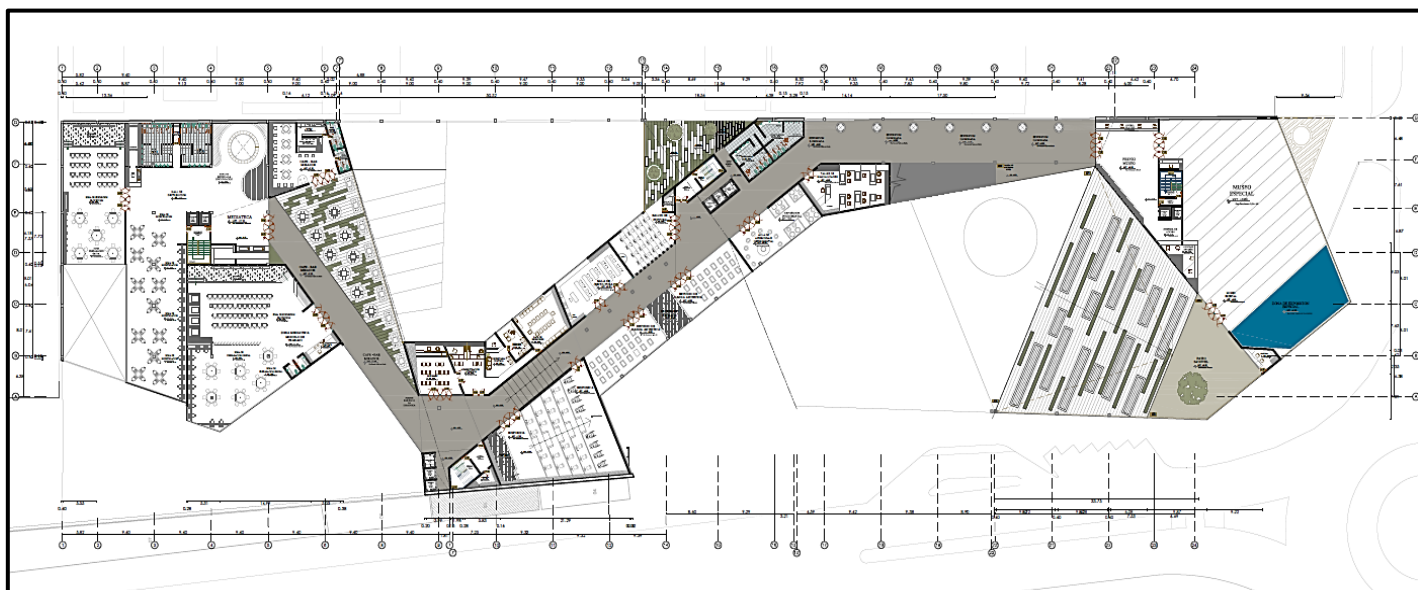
Planta de 2do Nivel Proyecto Parque Cultural
